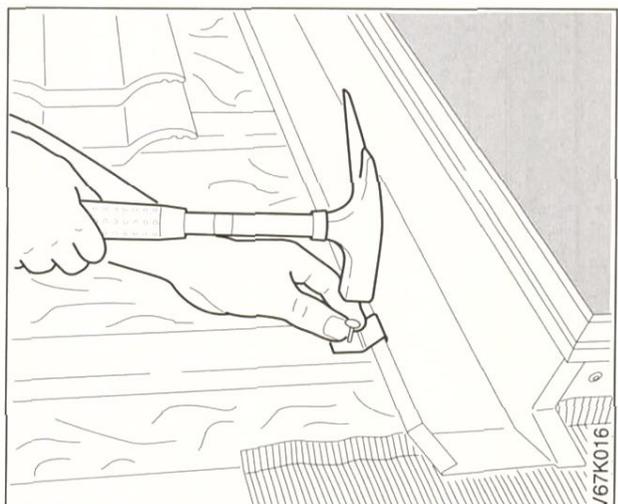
Seitenbleche mit drei Befestigungshäften auf Dachlatten festnageln.
